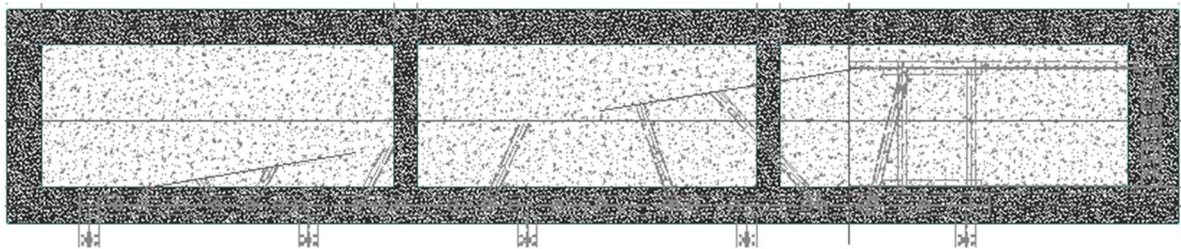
Disegno 3.6.1: Vista in pianta della fondazione della scala della passerella
